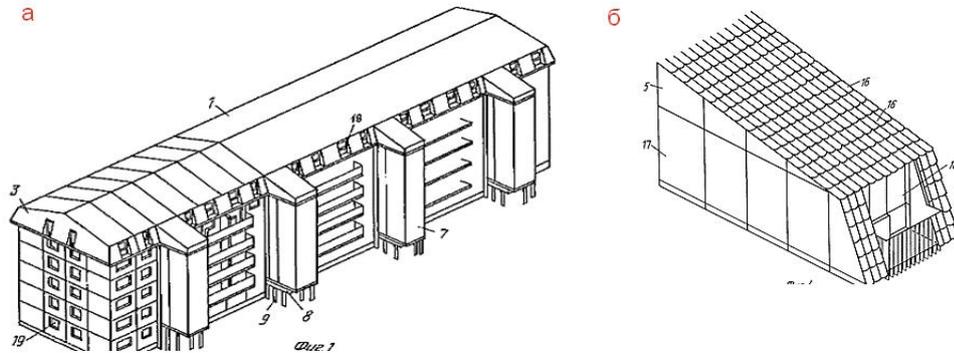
Вариант комплексной реконструкции жилого пятиэтажного дома первых массовых серий 1950-х гг. с надстройкой дополнительного этажа: а – внешний вид дома после реконструкции; б – объемный блок для мансарды (примечание: нумерация указана согласно патенту, описание – далее в тексте) [9]
